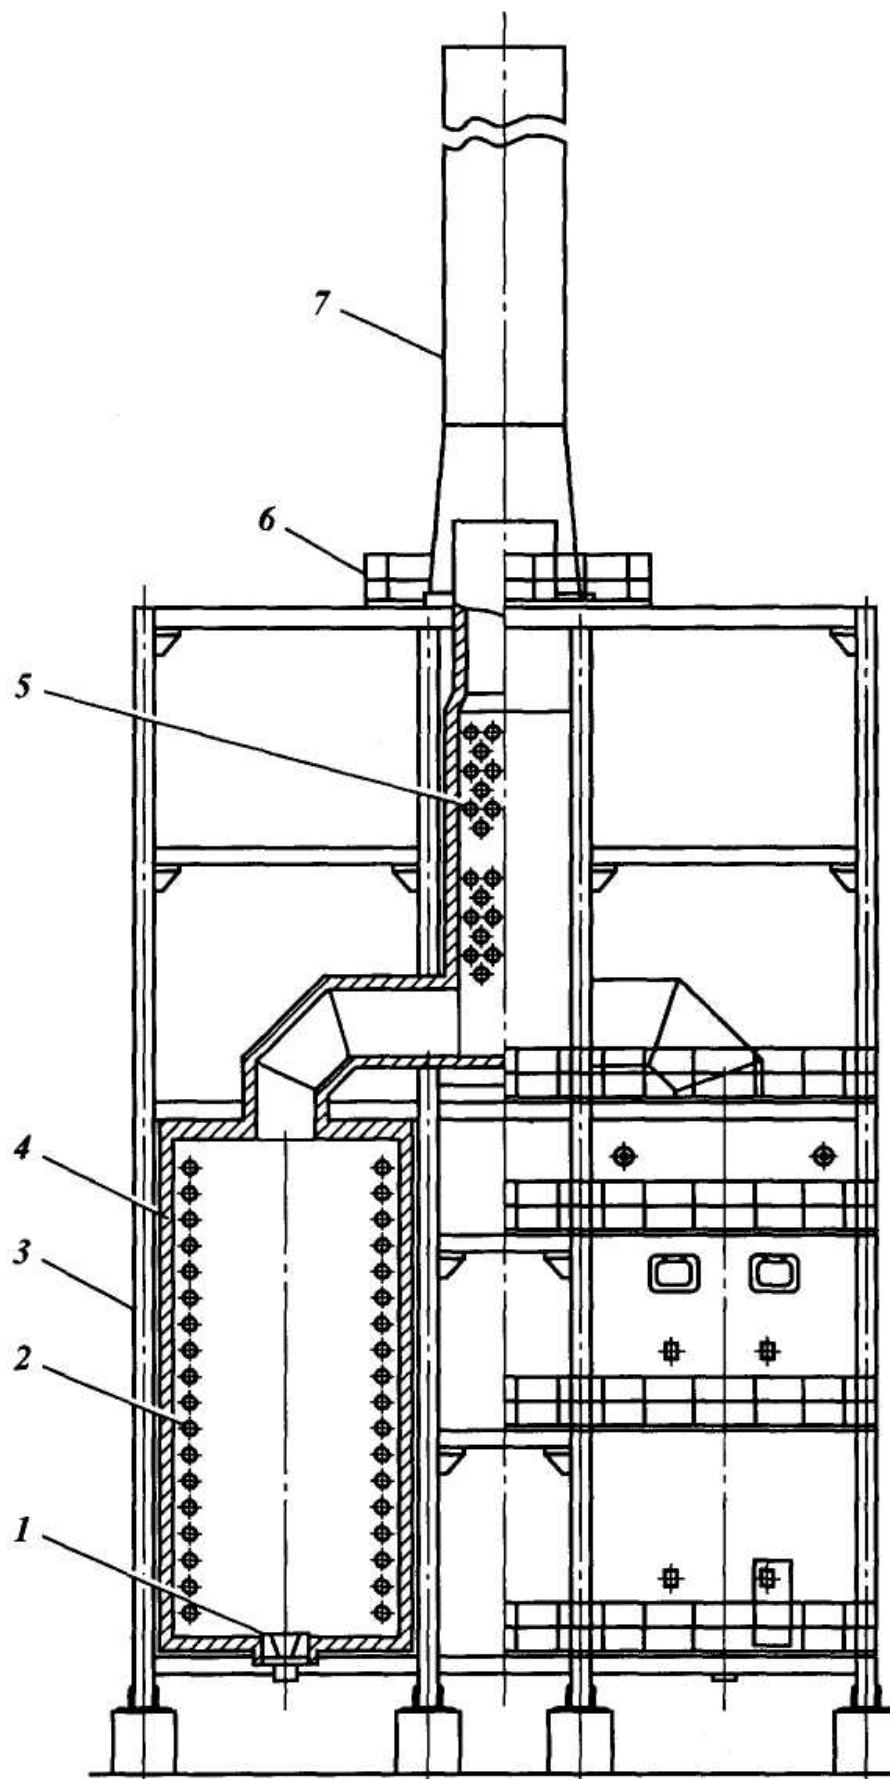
Конструкция трубчатой печи типа ГС2:
